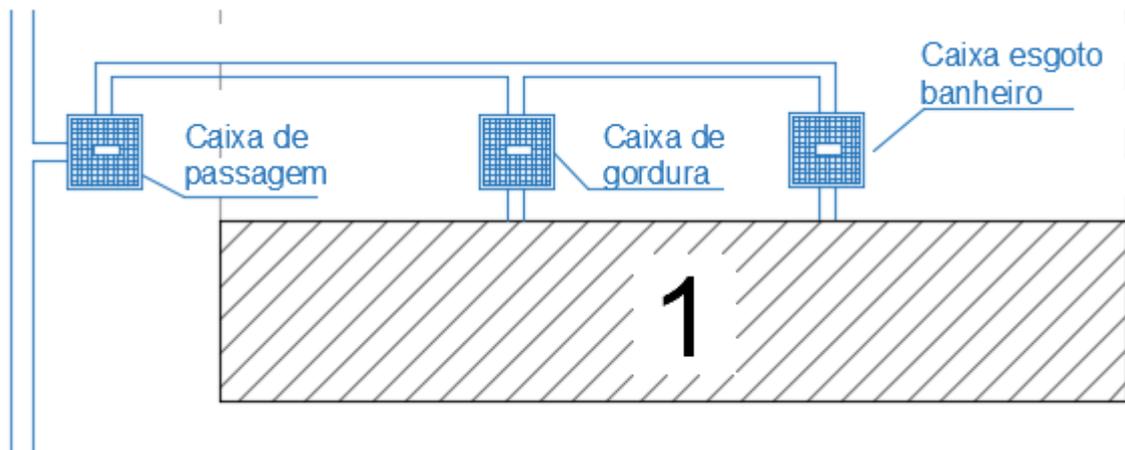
Planta da coleta de esgoto da habitação emergencial.
